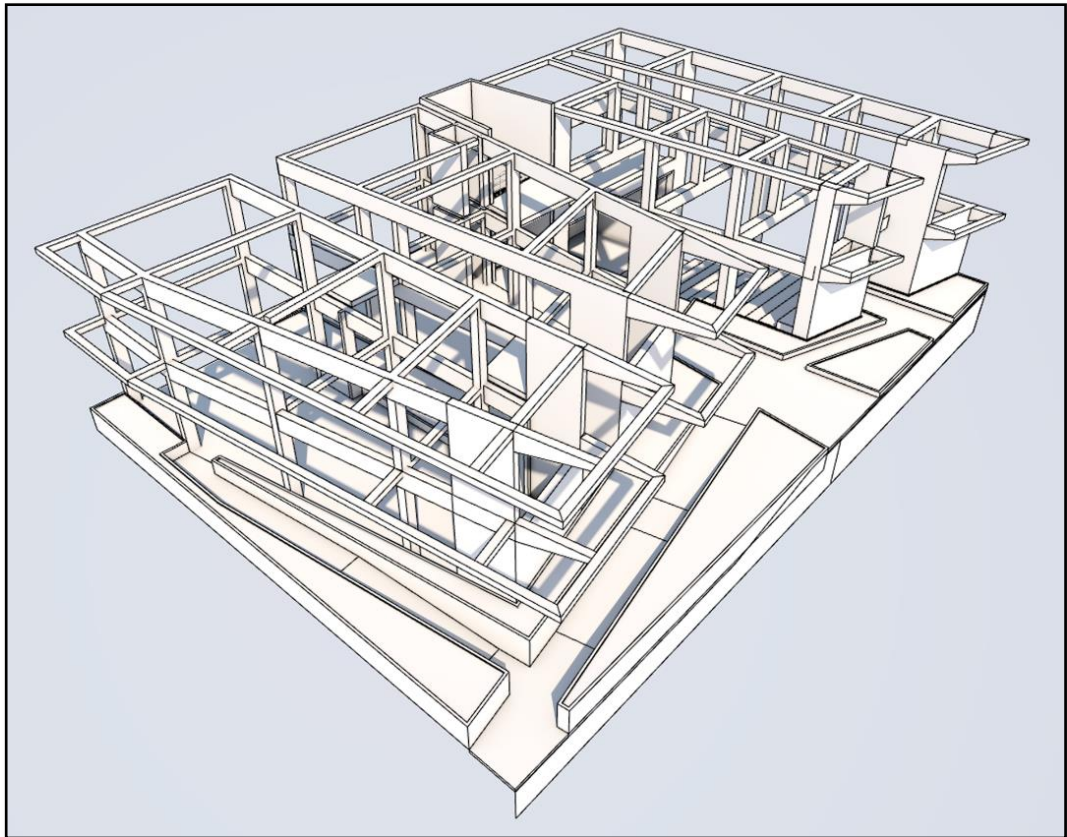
La estructura del palacio municipal, donde se muestran los diferentes elementos estructurales como placas, columnas y vigas.
